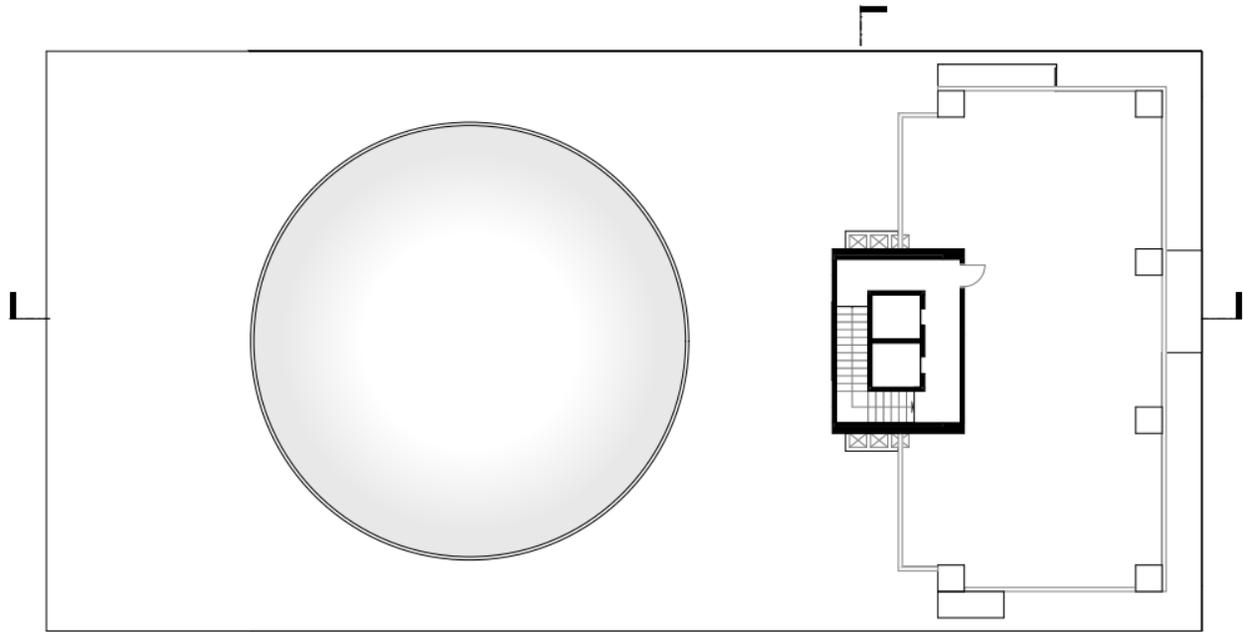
Planta alta actual N+24.50. Fuente: Tesistas.
